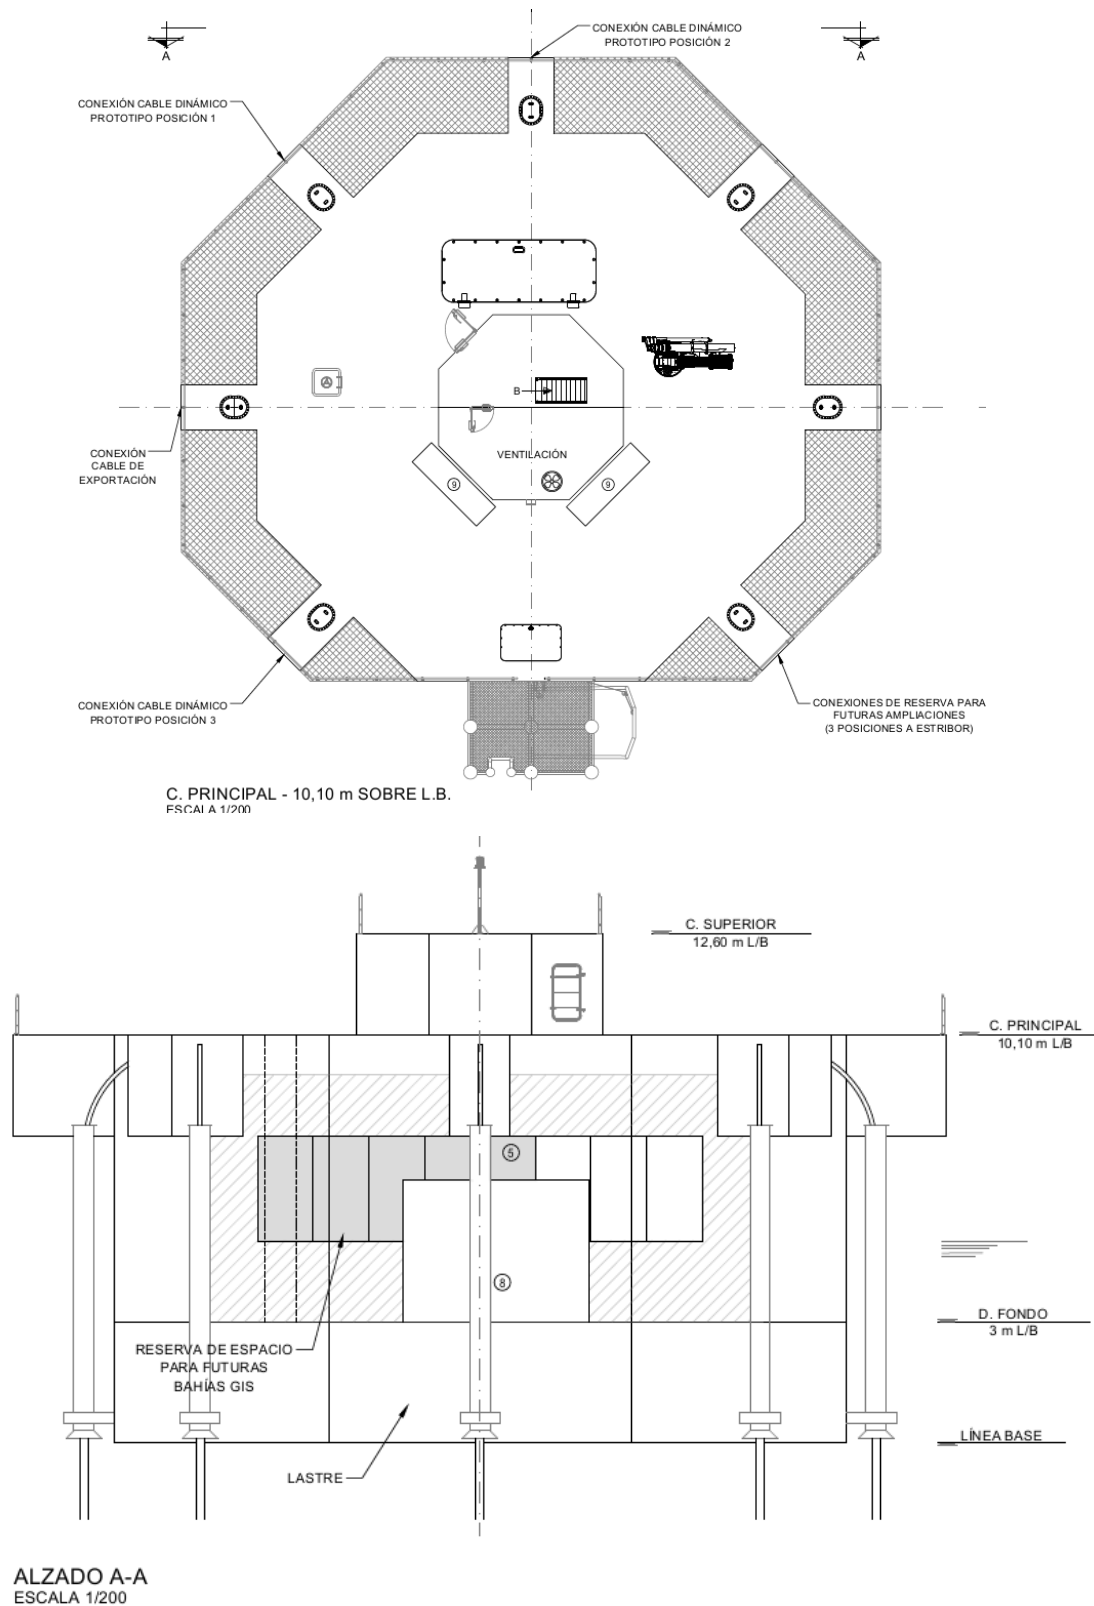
Esquema en planta y alzado de la boya de interconexión.
